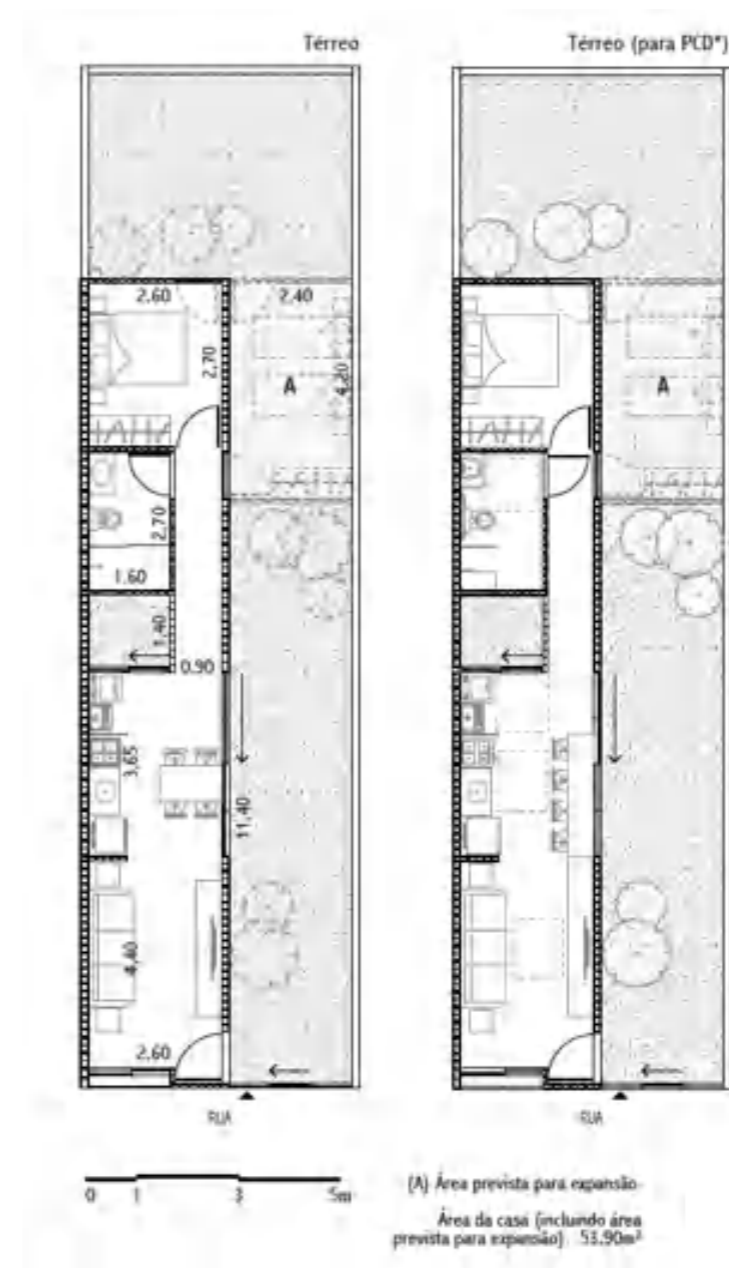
Planta baixa do pavimento térreo da unidade habitacional vencedora do Grupo 01.
